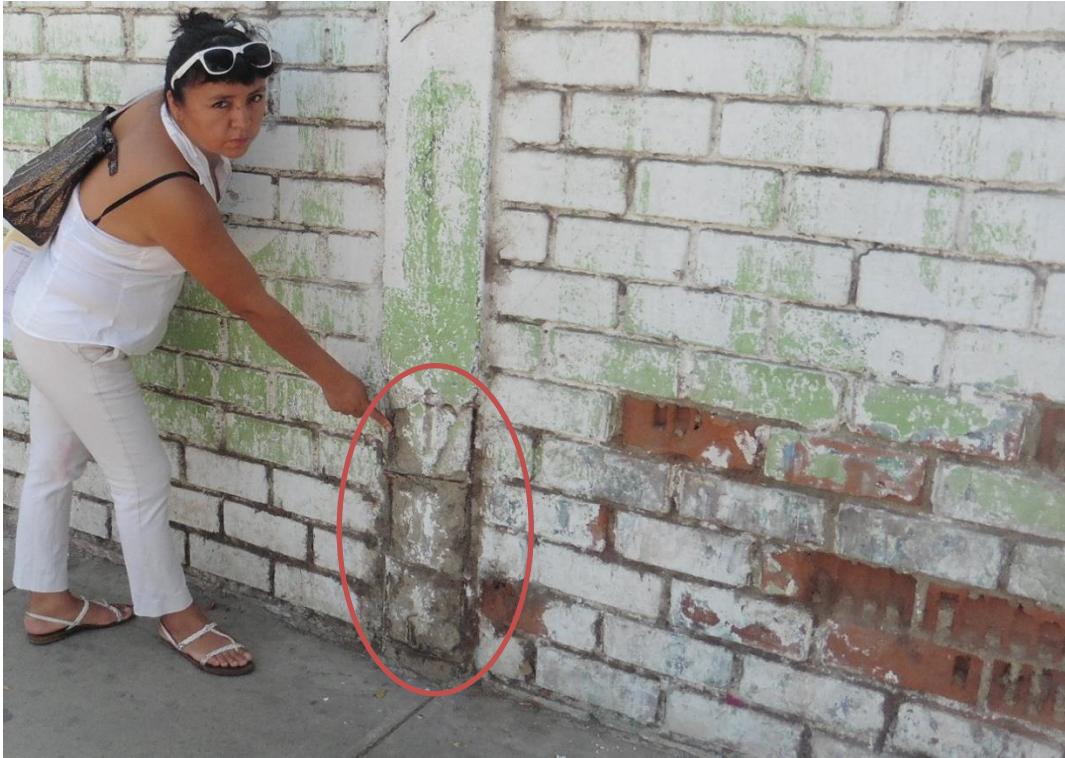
Deficiencia en el proceso Constructivo. (No se consideró columnas ni viga).
